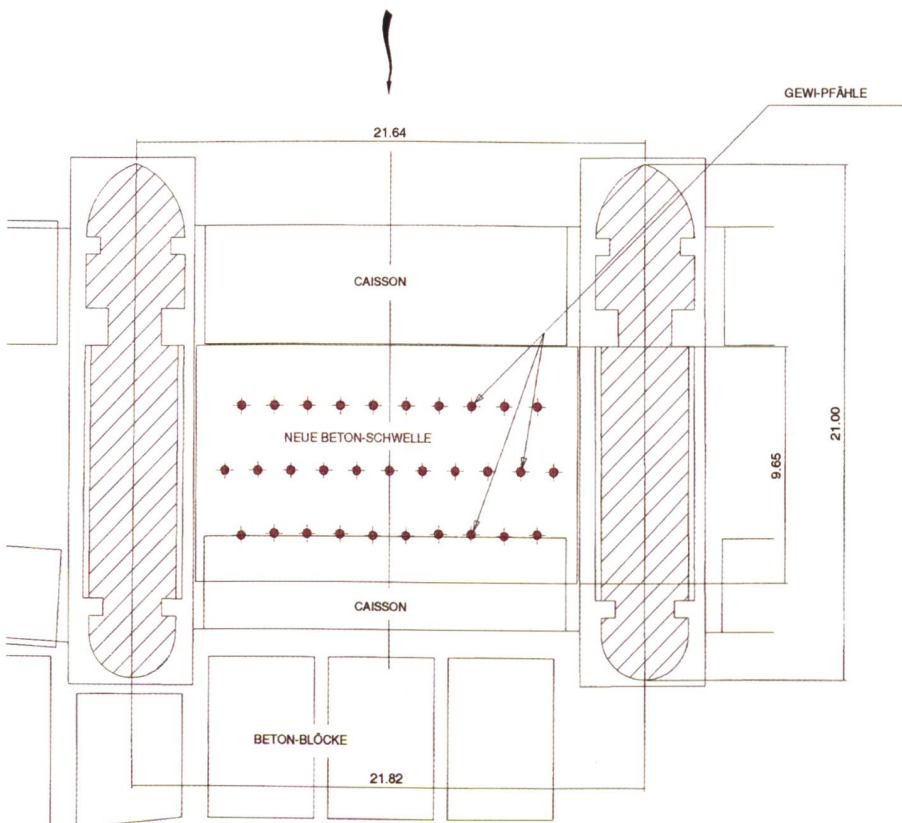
Grundriss eines verstärkten Wehrfeldes.
